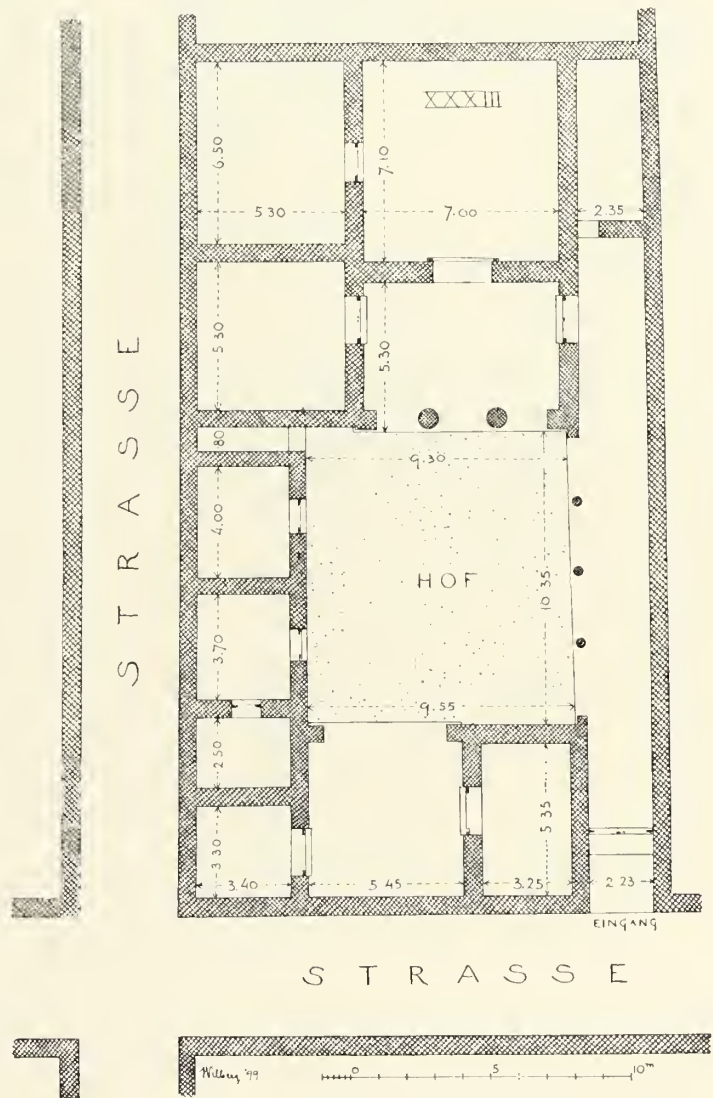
Grundriss des Hauses Nr. XXXIII in der ursprünglichen Anlage.
